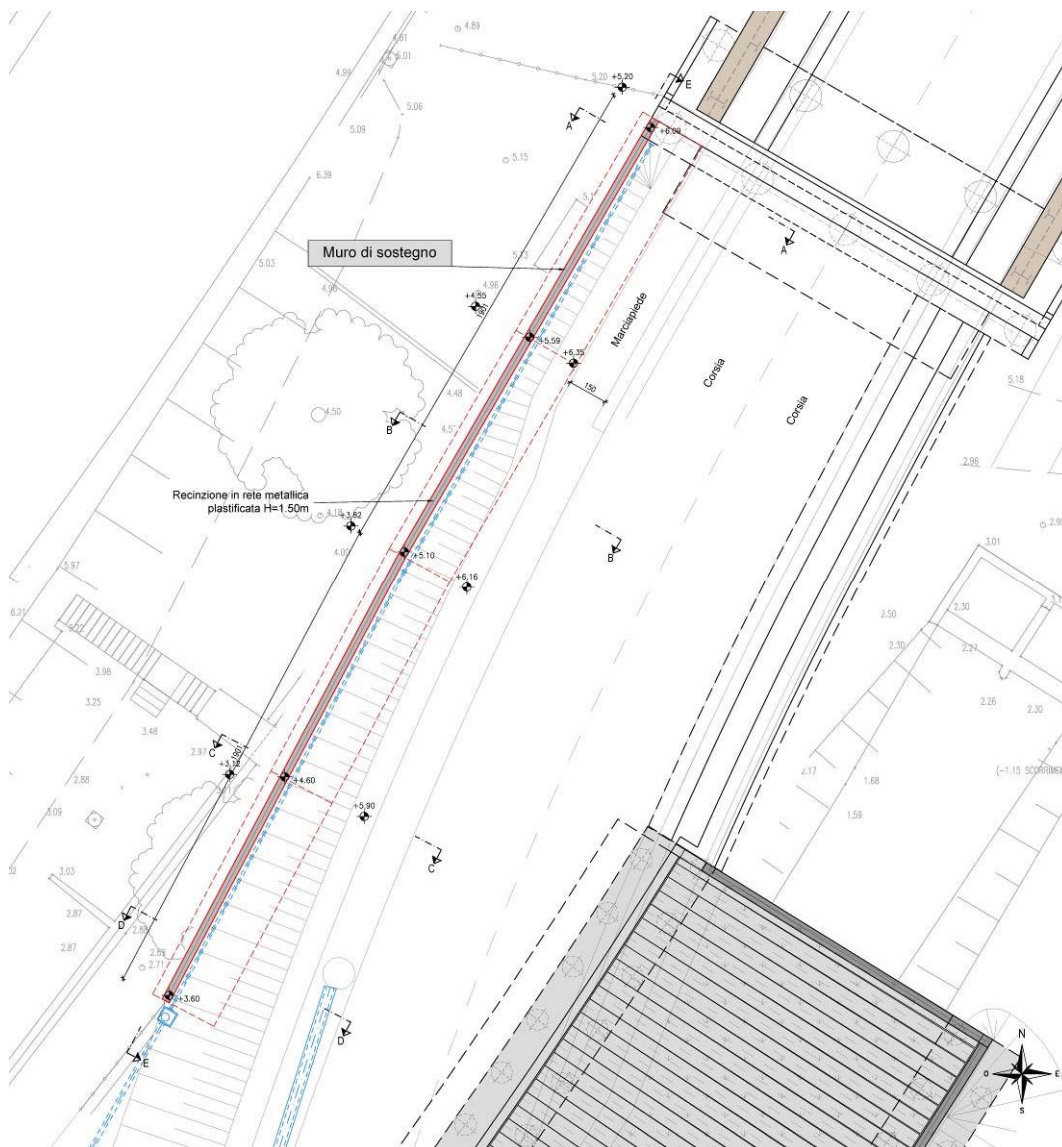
Muro di sostegno sud – Pianta e Prospetto
